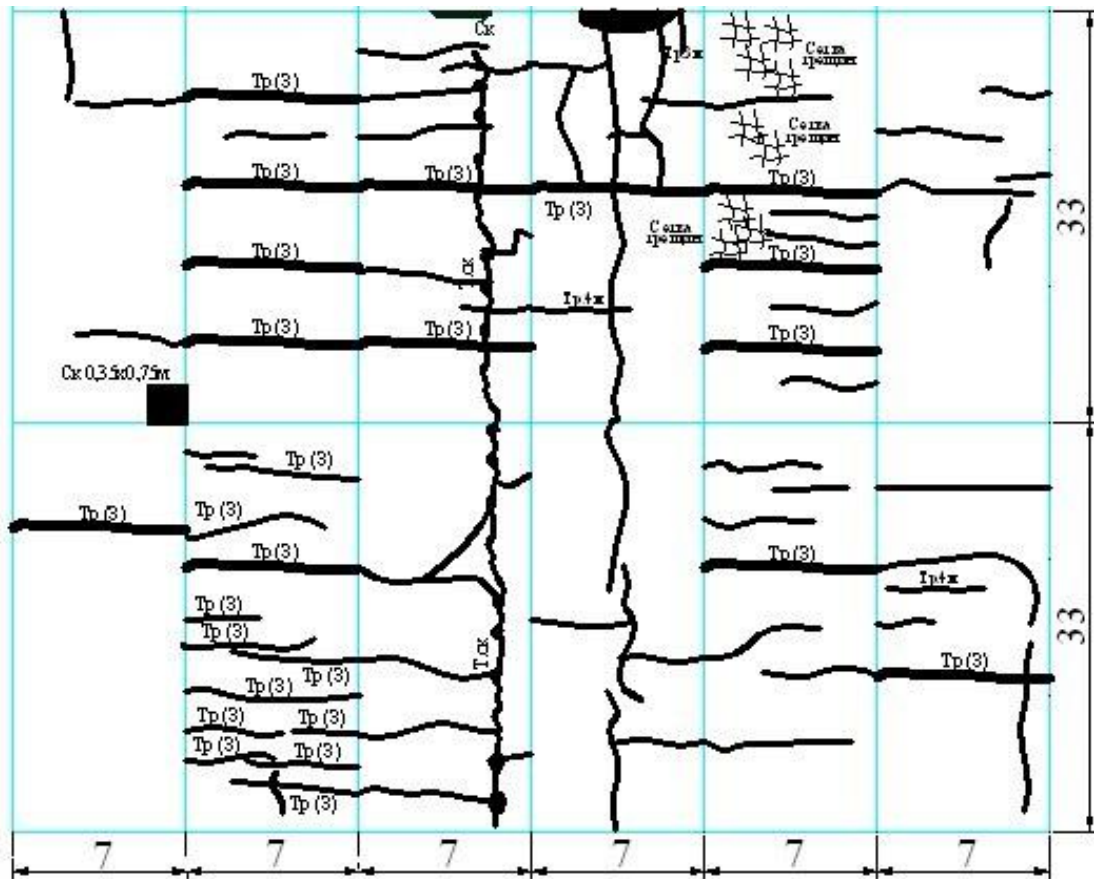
Фрагмент дефектовочного плана армобетонного покрытия
